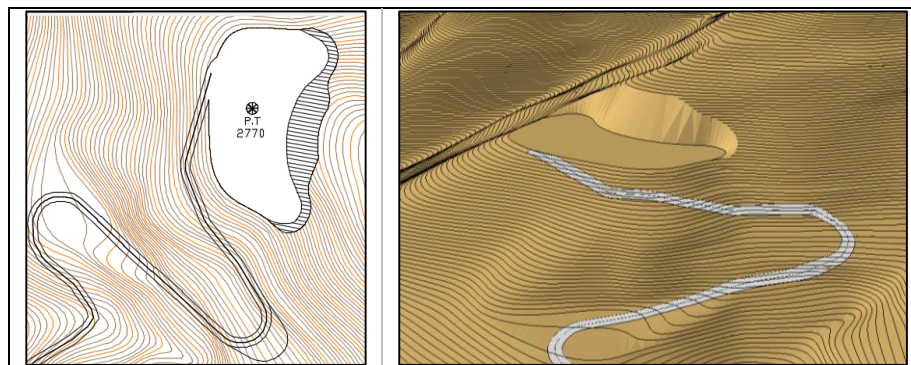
Vista en planta y en 3D de la Fase 1 de explotación
